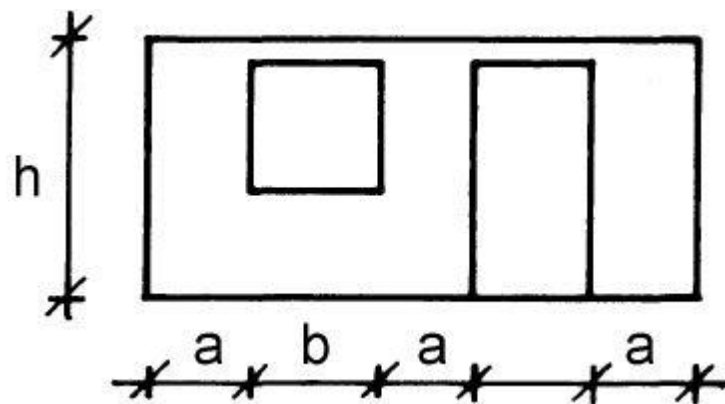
Longitud entre vanos. Adaptado: Manual de construcción para viviendas antisísmicas
